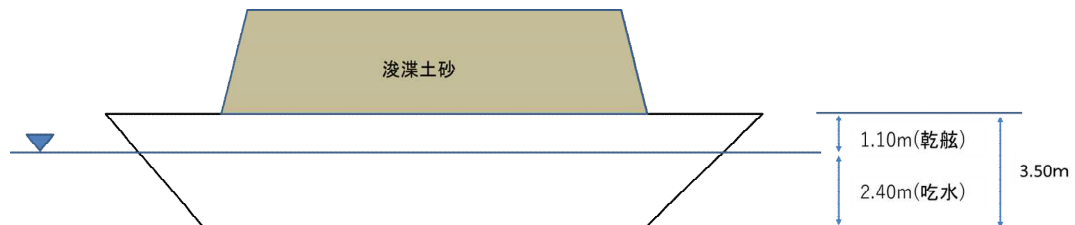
(参考-3) 土運船乾舷確認写真 (浚渫土砂積載状態) イメージ図
